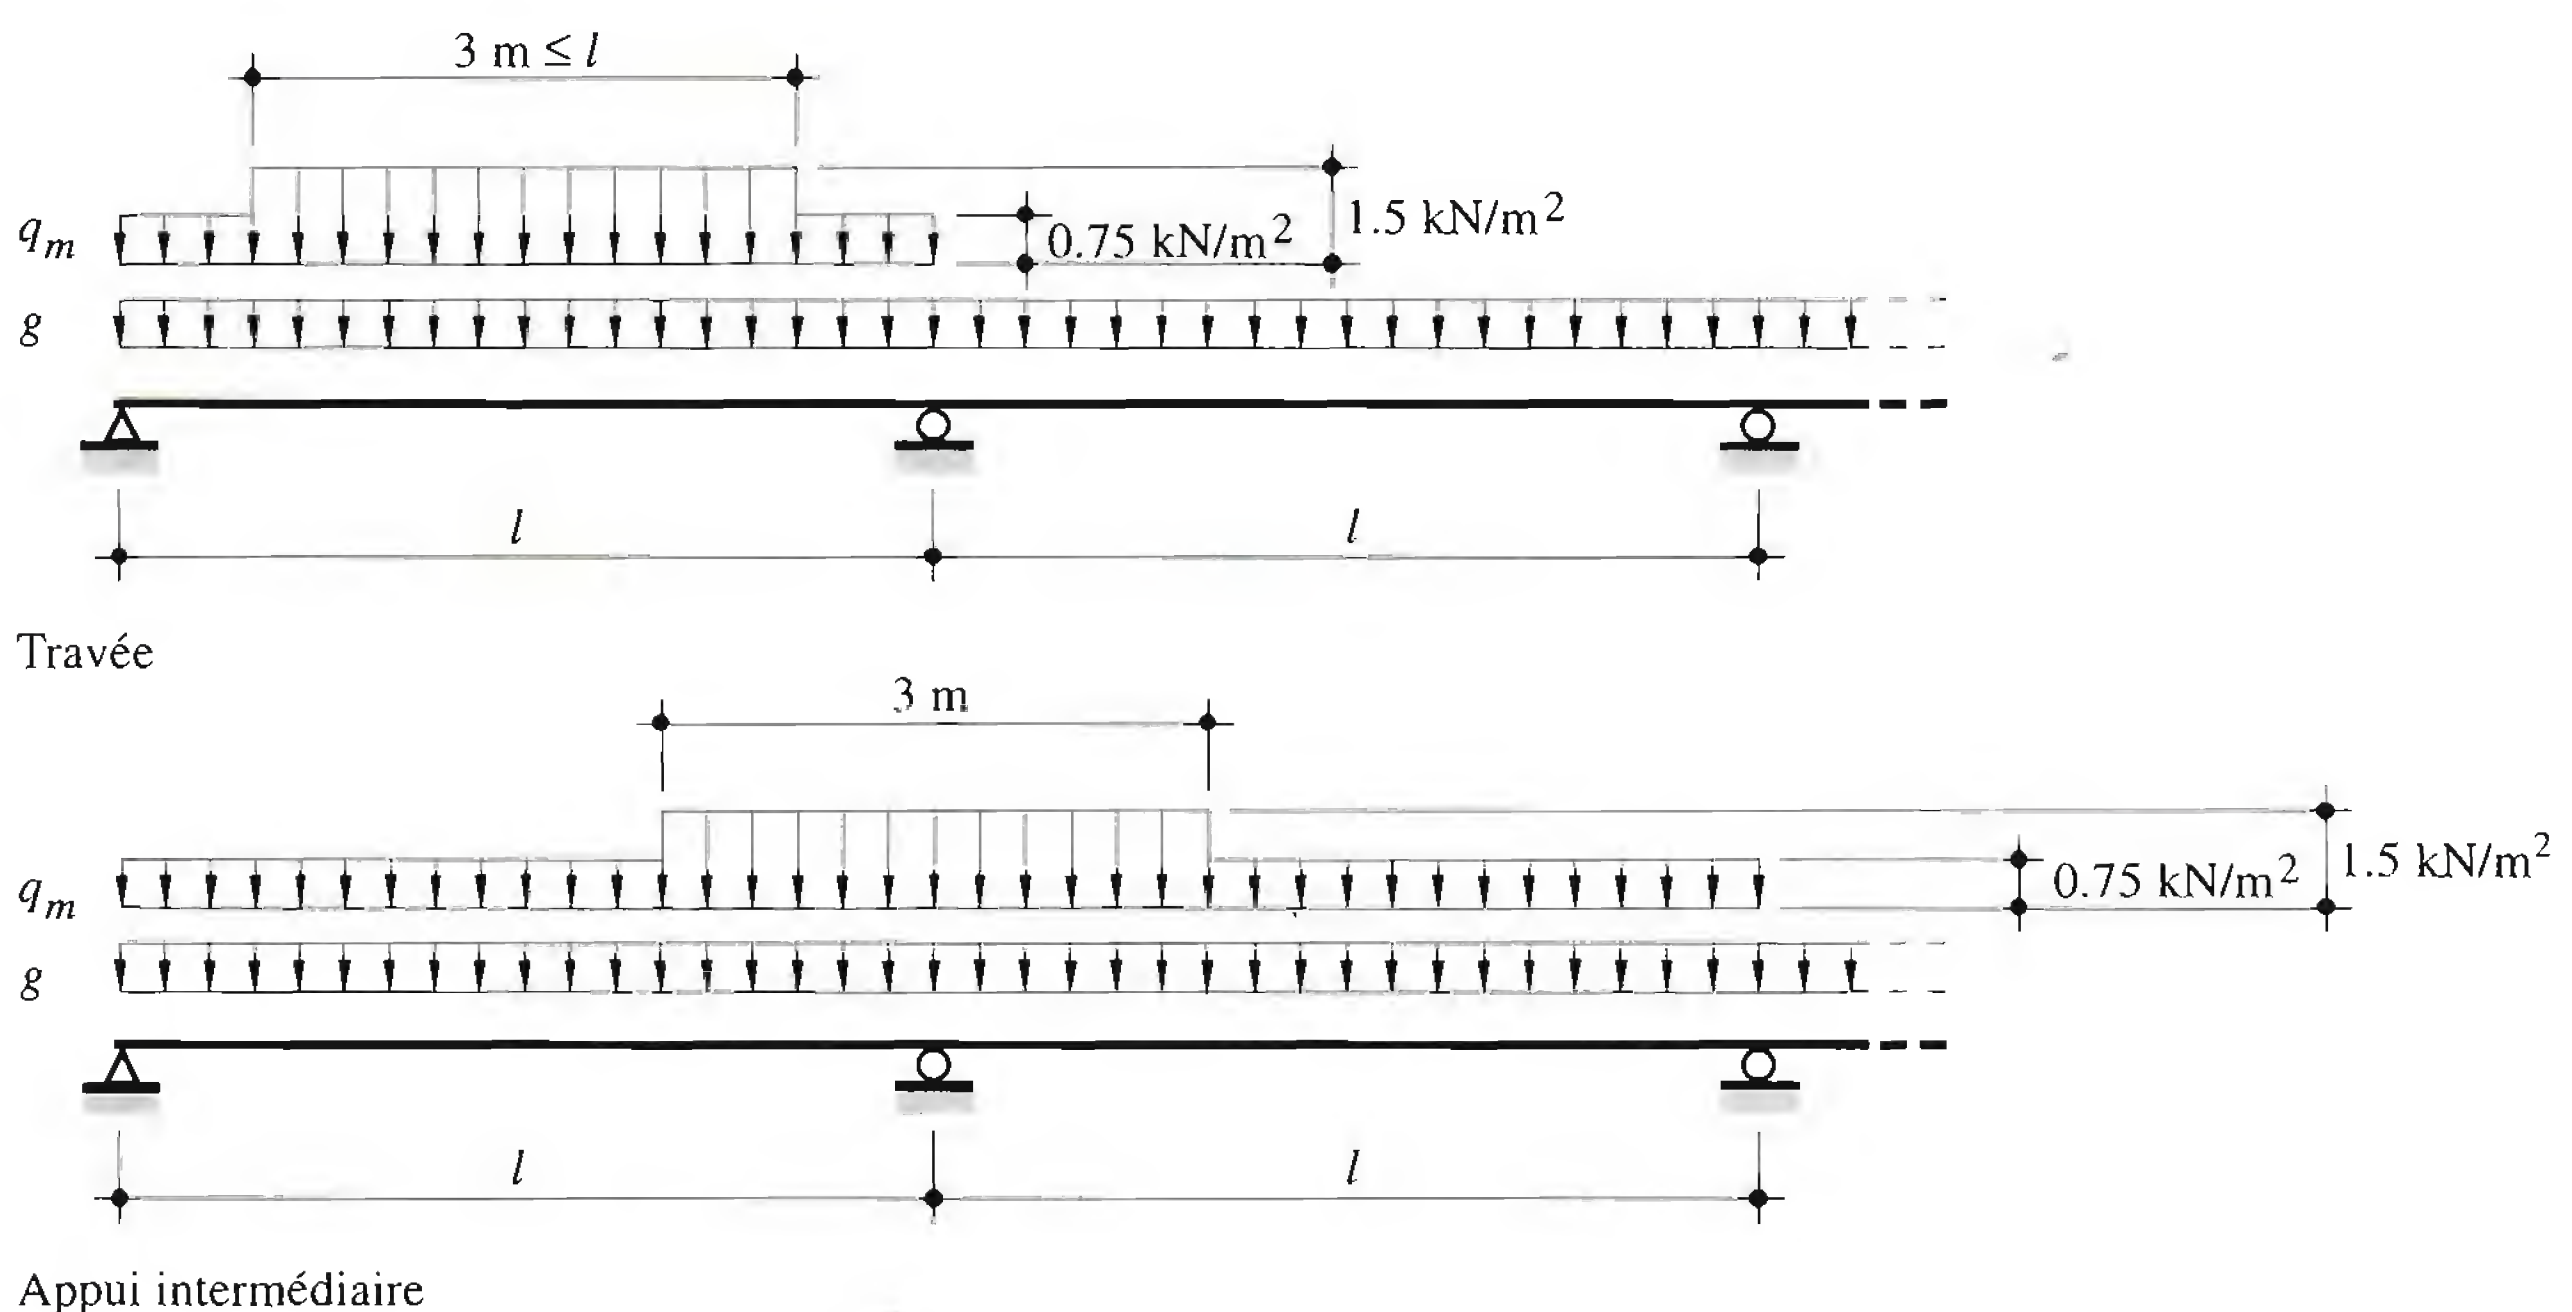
Charges de construction sur une tôle profilée de dalle mixte.
